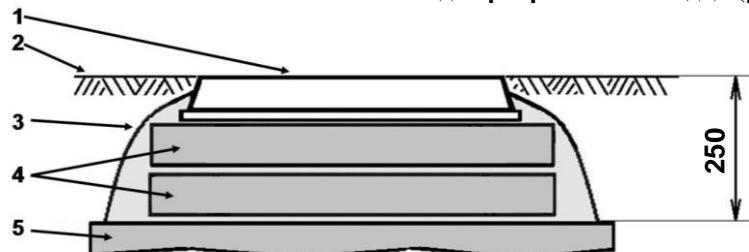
Расстояние от перекрытия колодца до уровня земли (асфальта) на тротуаре и газоне должно быть – не менее 250 мм:
